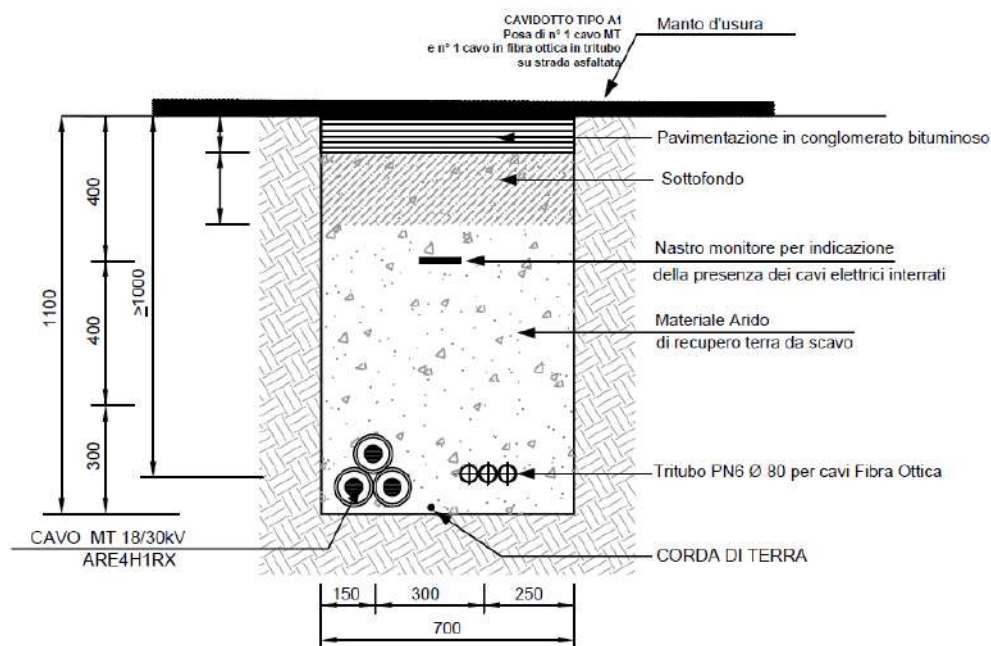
Sezione tipica di posa della linea in cavo su sede stradale
